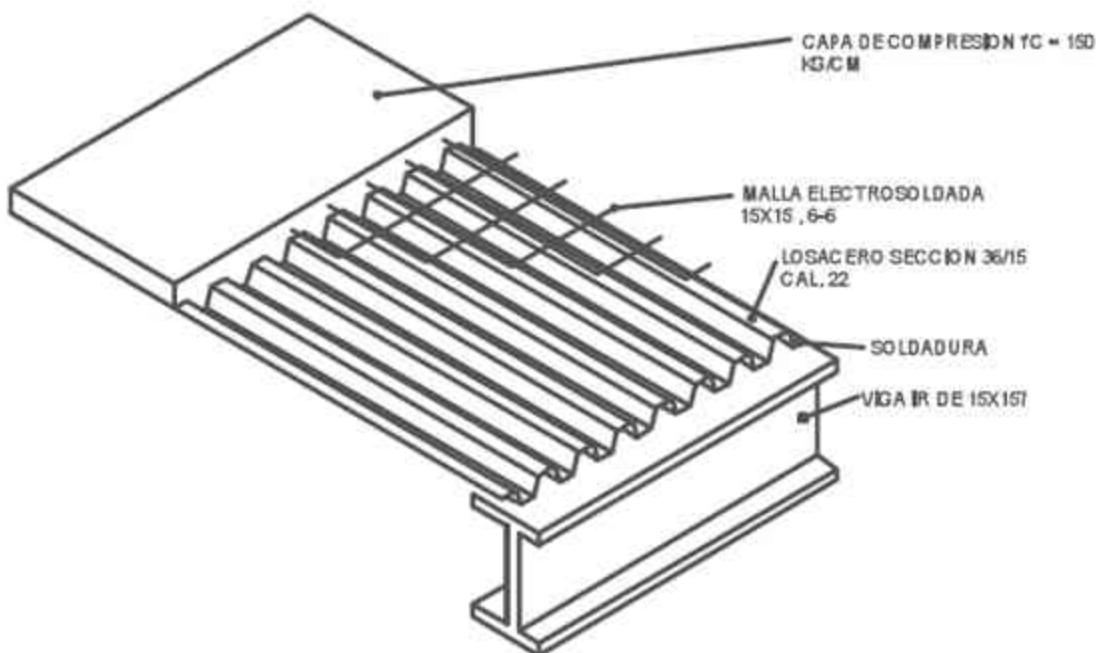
Detalle de Losacero con el apoyo de la viga IR.
